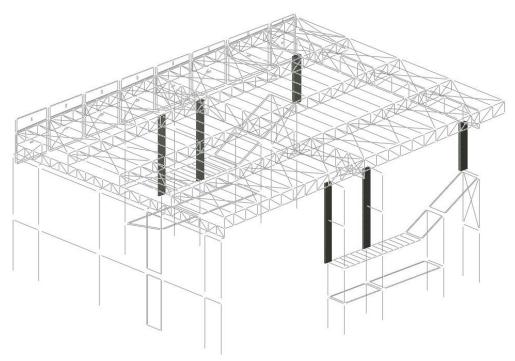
Esquema de Columnas de apoyo de cubierta. Tramos inferiores existentes y superiores a ejecutar.
